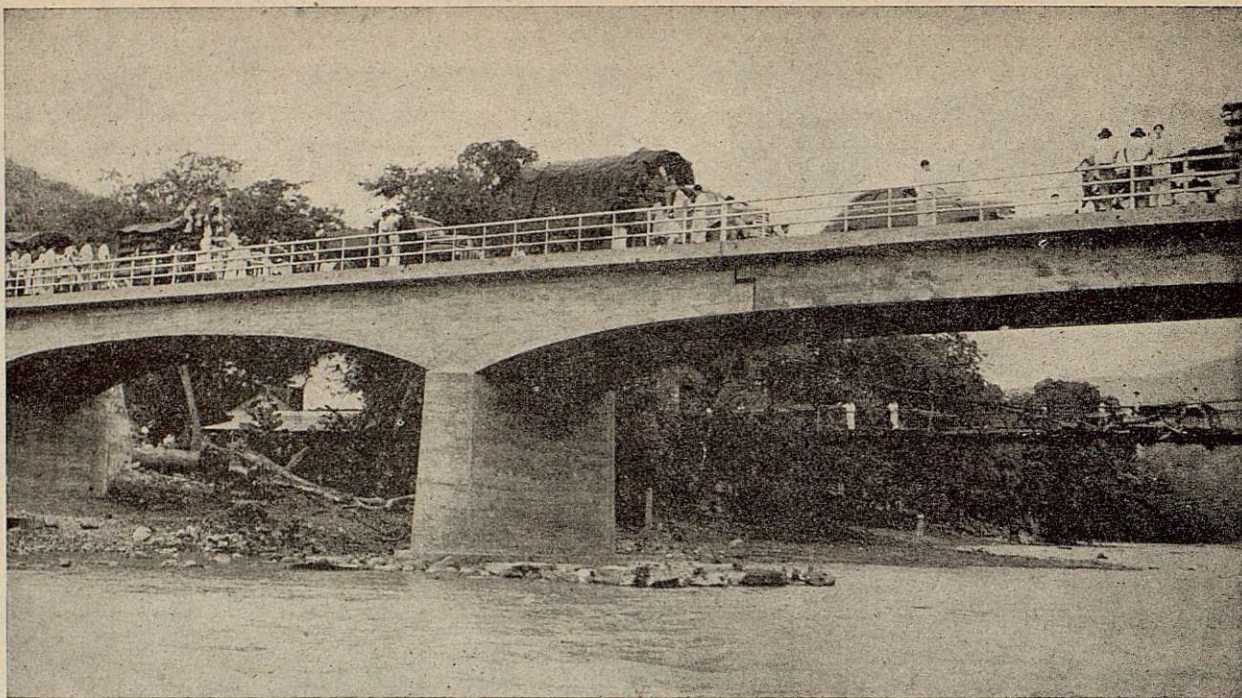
Detalle. Pila central y apoyo del tramo de 18 metros, durante la inauguración del puente.
